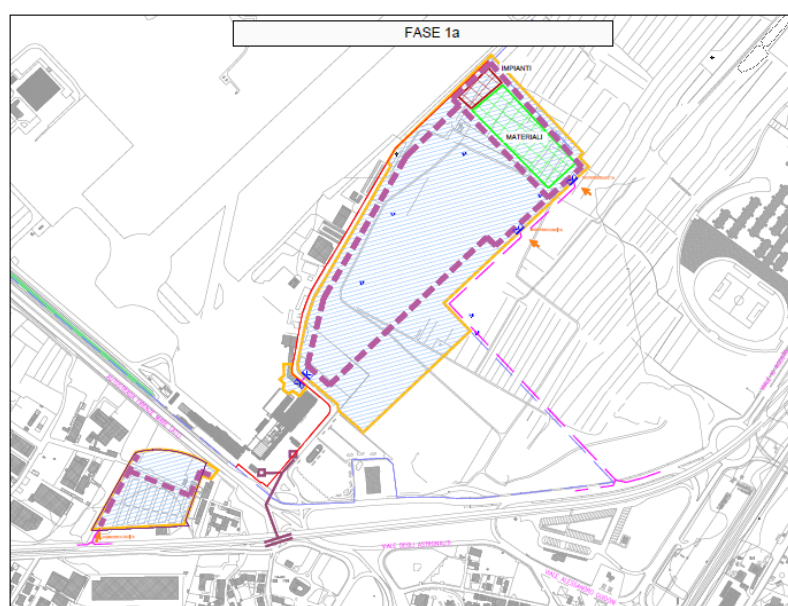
Cantierizzazione dell'Area Nuovo Terminal – Fase 1a
